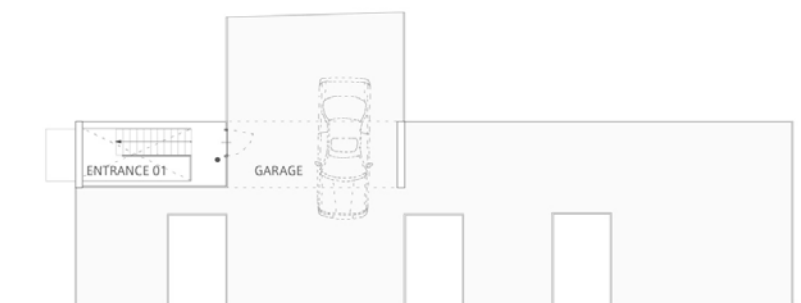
Roof House (Arkitekt: Tezuka Architects, MASAHIRO IKEDA co.,ltd
